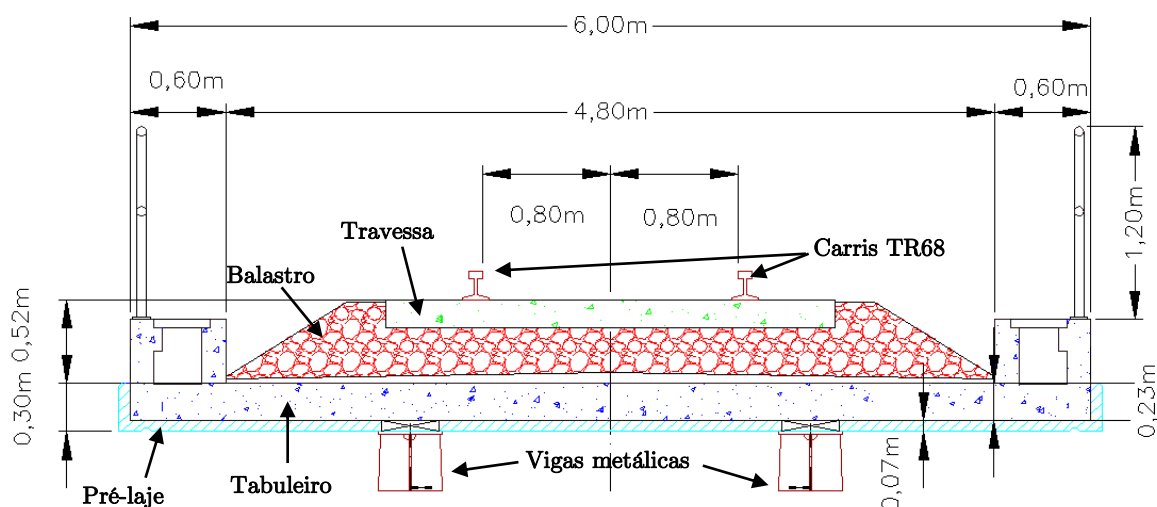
Seção transversal do tabuleiro e da via balastrada
